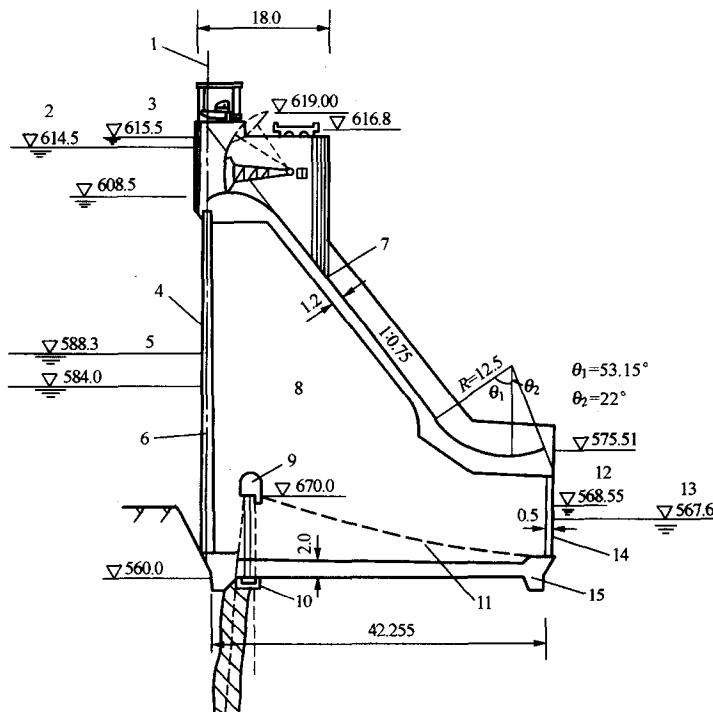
坑口碾压混凝土坝溢流坝段剖面图（单位：m）
